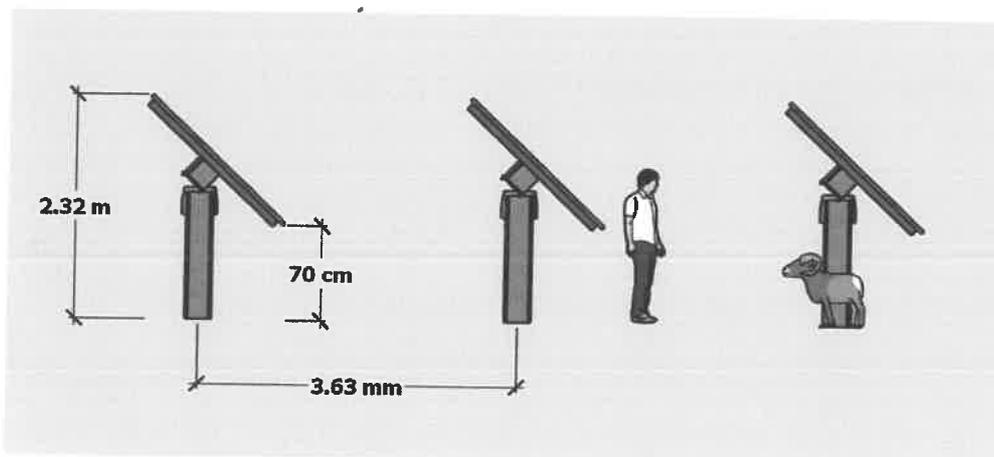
Plan de coupe des structures Trackers (50° d'inclinaison), Albioma
